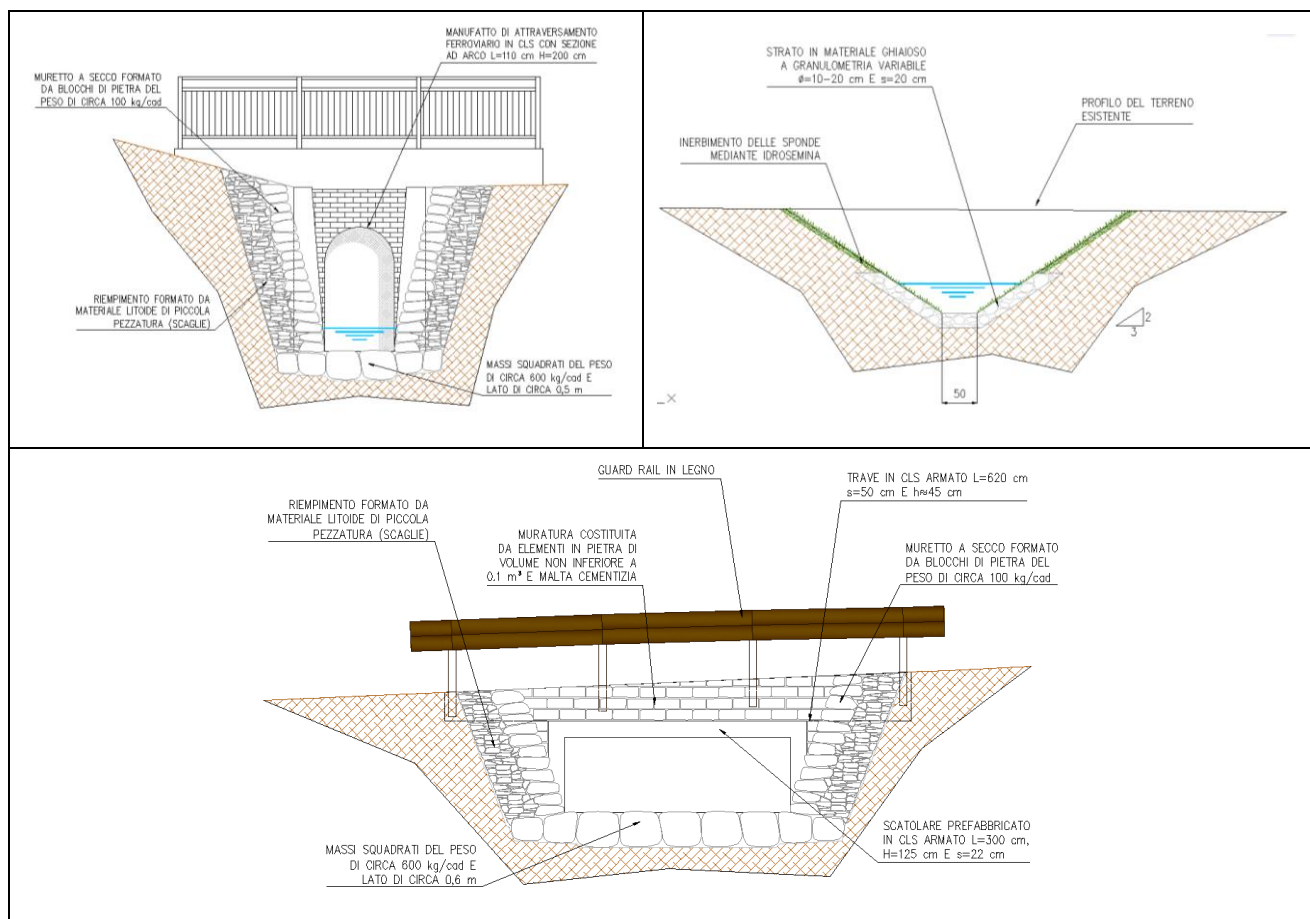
a) sezione di sbocco dalla ferrovia; b) sezione tipologica "F" tra la ferrovia e via monte Barro; c) attraversamento della roggia sotto via monte Barro
